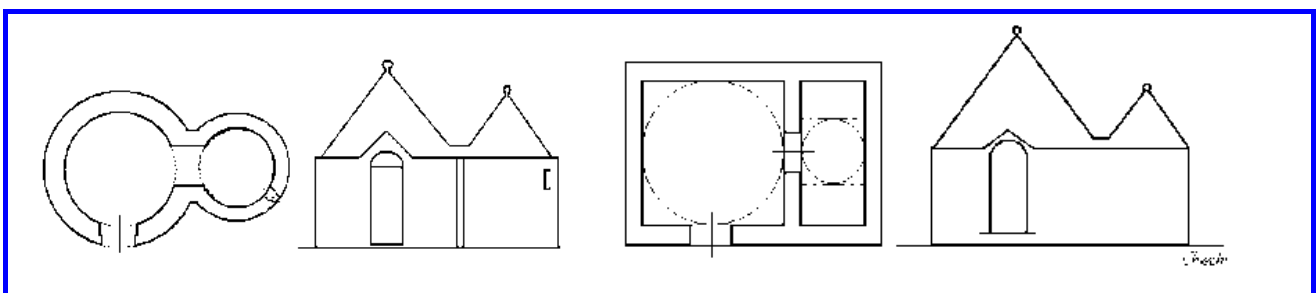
tipologie di trulli rispettivamente a pianta circolare e a pianta quadrata
